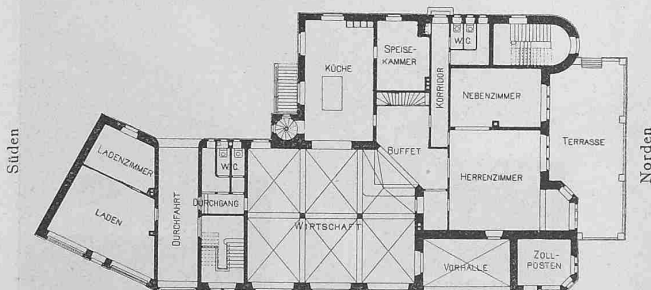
Grundriss vom Erdgeschoss. — Masstab 1:500.
